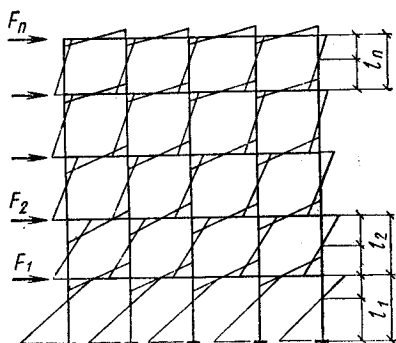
К расчету многоэтажных рам на горизонтальные нагрузки
